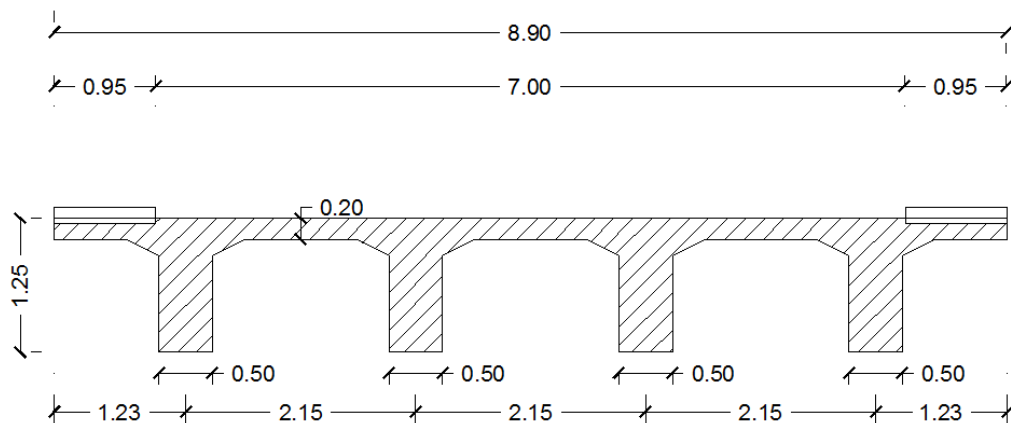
Secção transversal da ponte para a zona de meio vão. Adaptado de Jacinto (2011)
